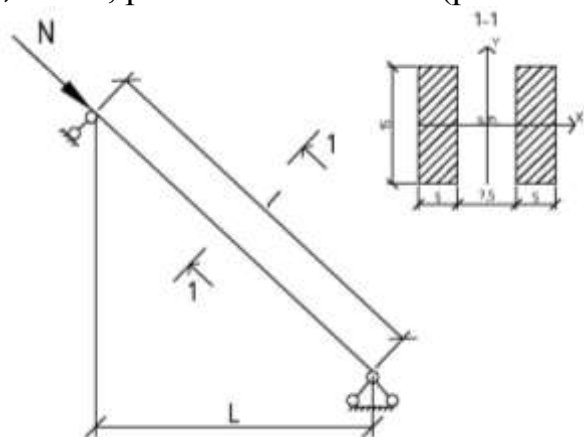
Расчетная схема подкоса стропильной ноги
